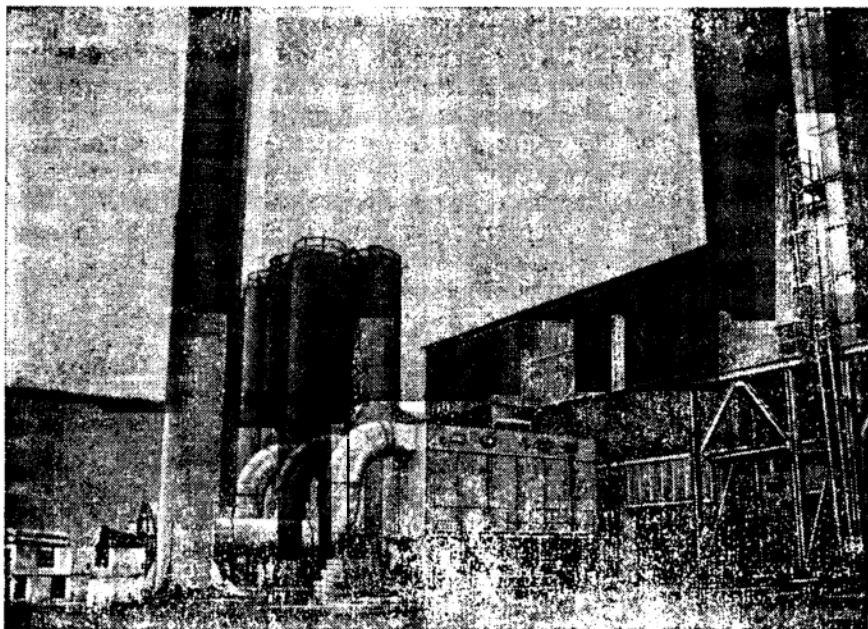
Агрегаты вытяжной вентиляции с сухими фильтрами вне здания цеха
